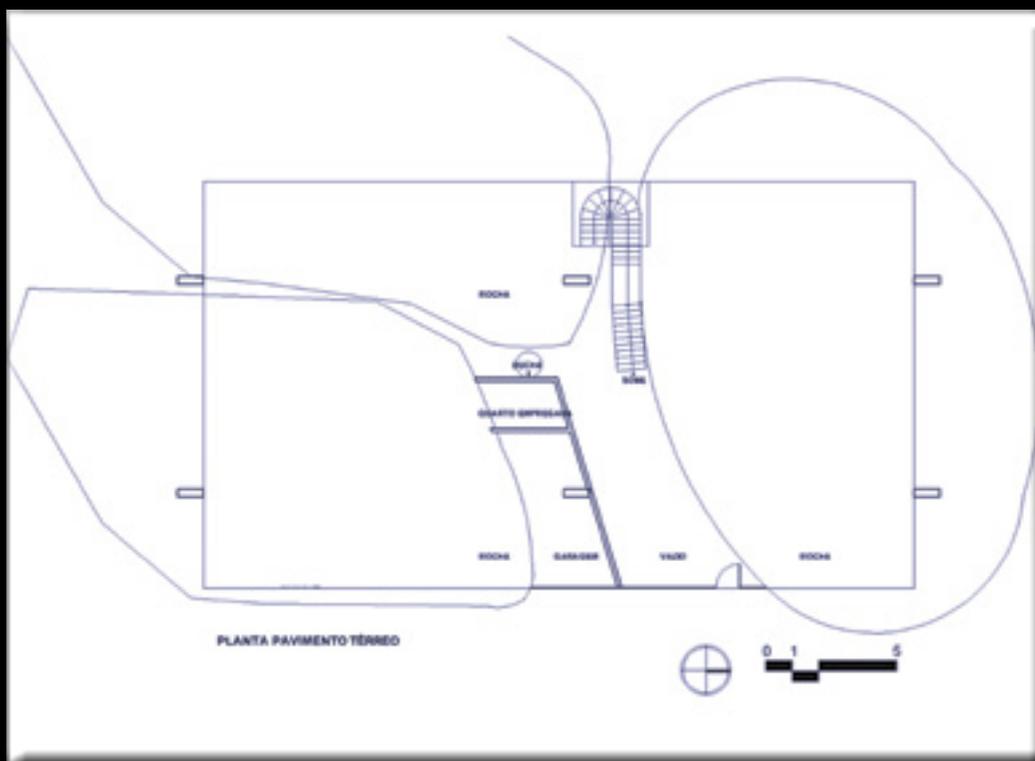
Planta baixa do pavimento térreo da Residência Guido Weber, Caiobá. (1965).
